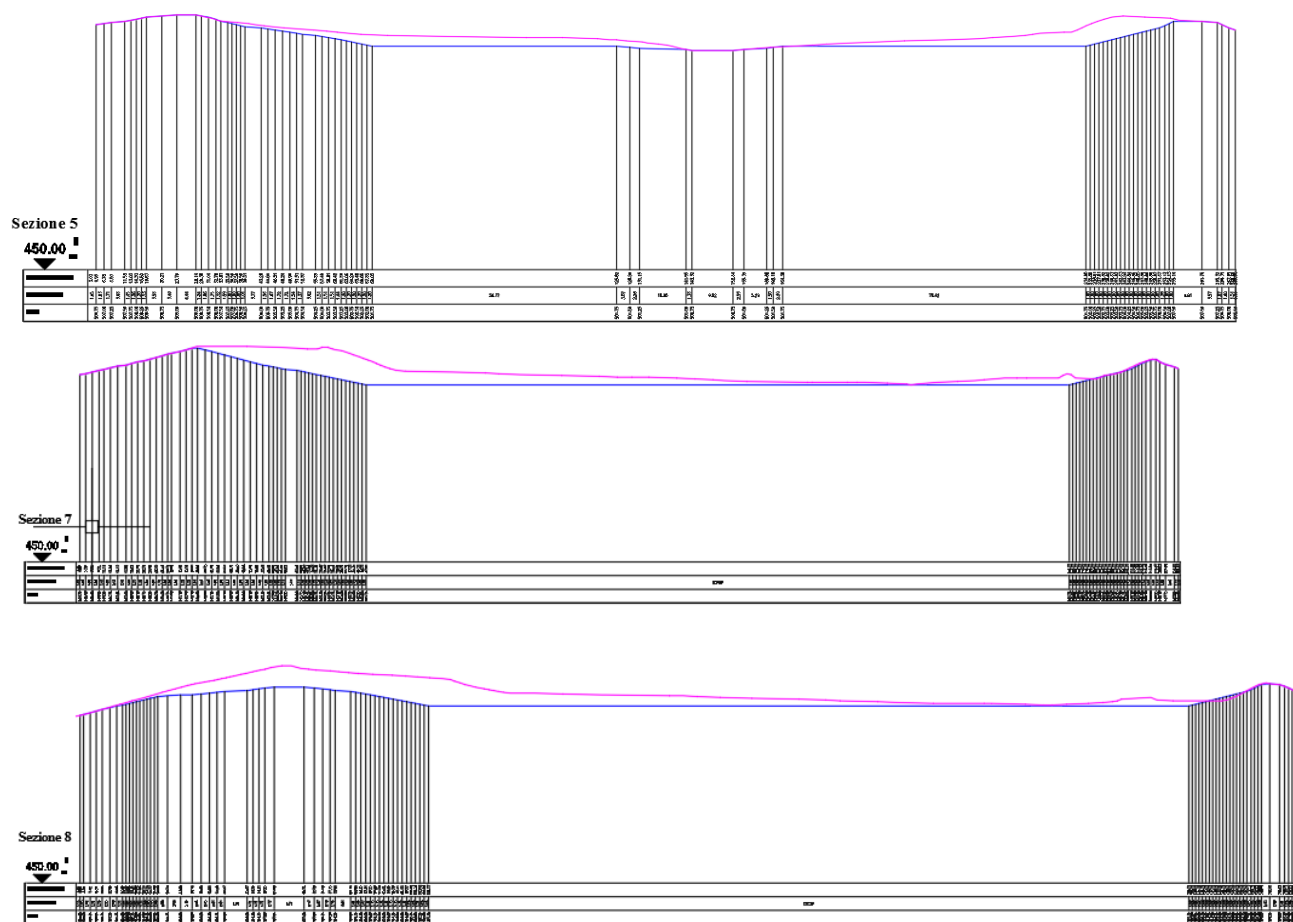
stralcio di alcune sezioni di raffronto tra stato attuale e finale a seguito del recupero
